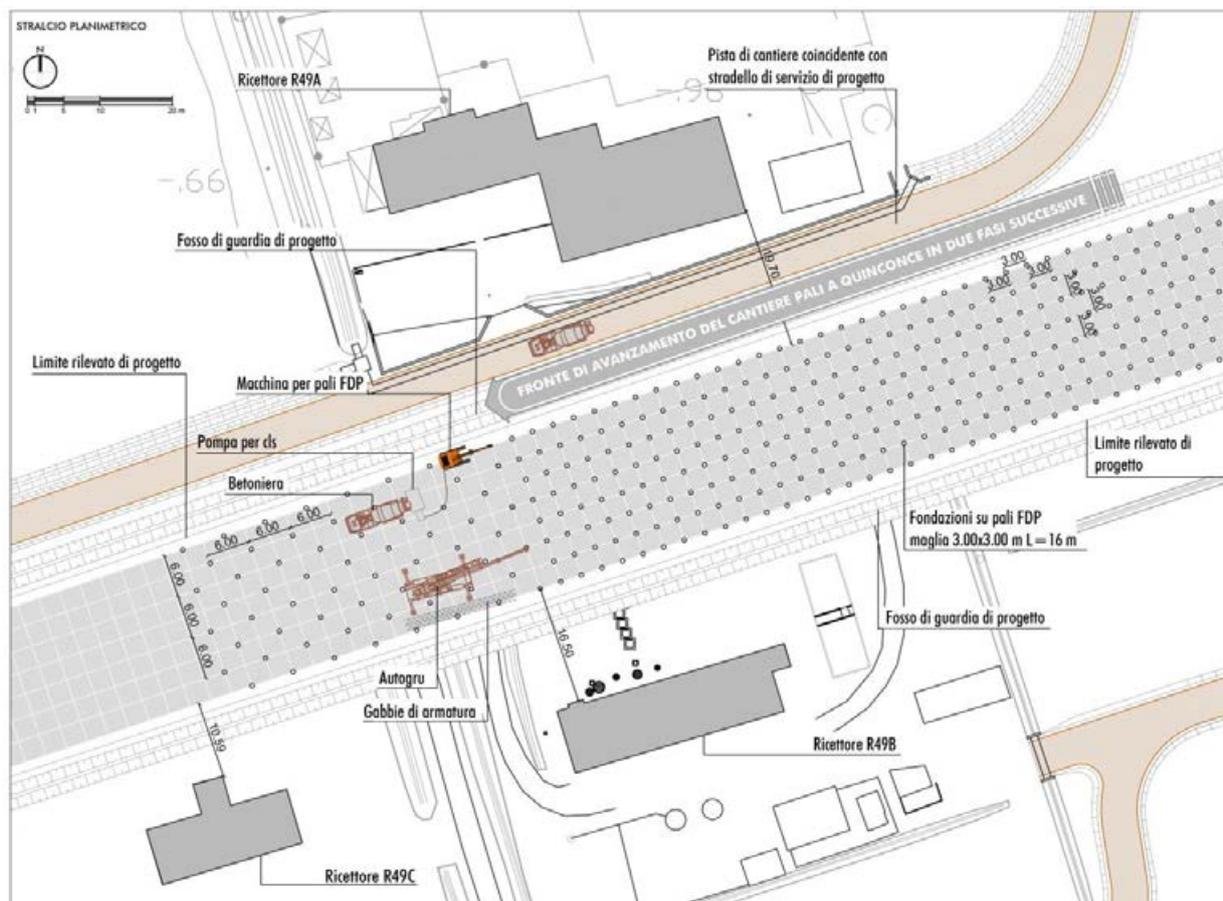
STRALCIO PLANIMETRICO DEL LAYOUT DI CANTIERE RIPORTANTE LE DISTANZE MINIME TRA I RICETTORI E I PALI
